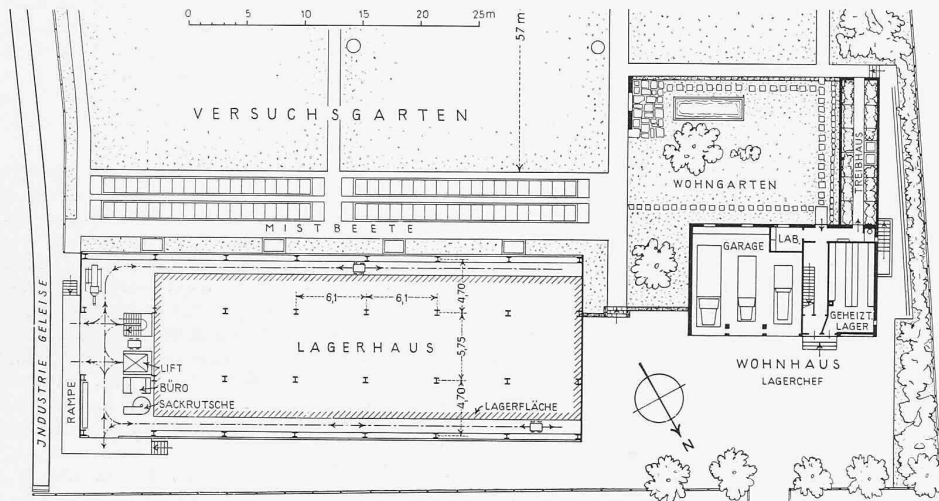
Lagerhausanlage G. R. Vatter. — Arch. HANS BRECHBÜHLER, Bern. — Lageplan 1: 600.
